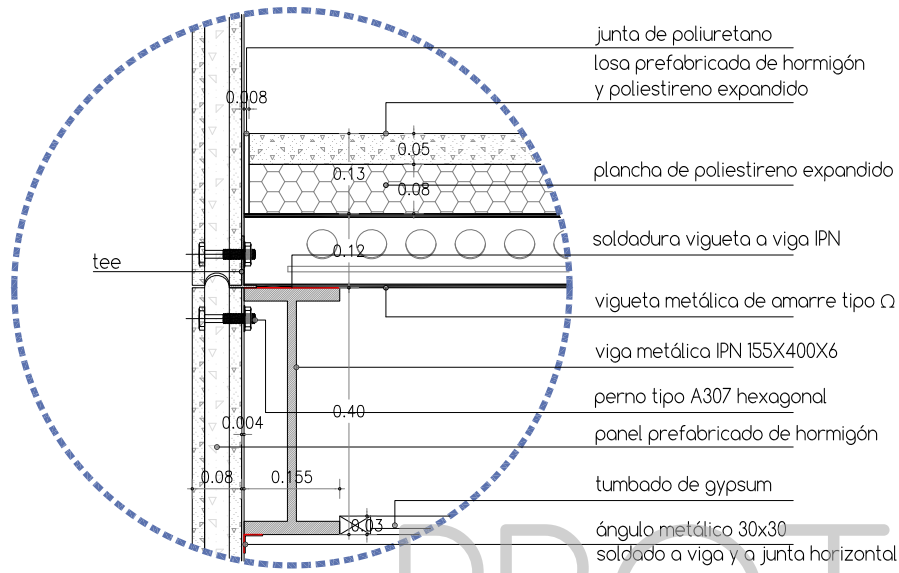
Detalle de viga-losa con paneles prefabricados
